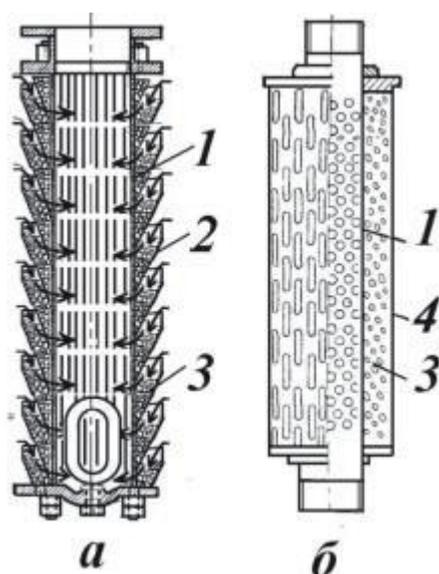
Фильтры гравийные: а – корзинчатый, б – кожуховый, 1 – трубчатый каркас; 2 – корзинка; 3 – гравий; 4 – удерживающая оболочка
